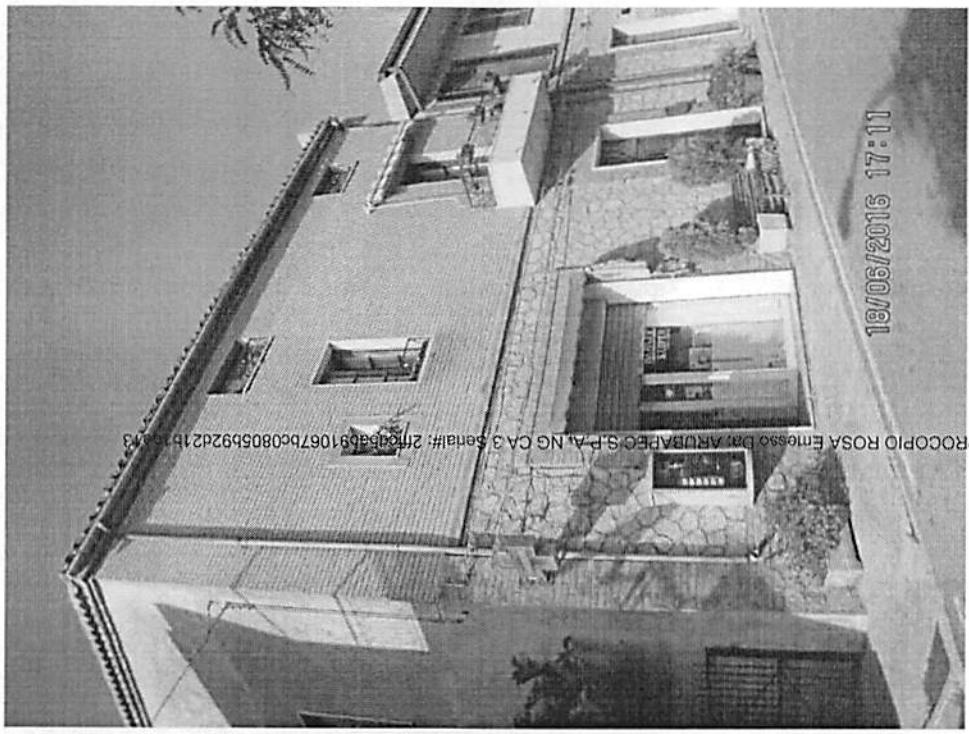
piano terra sub 12 – piano primo e sottotetto sub 13
